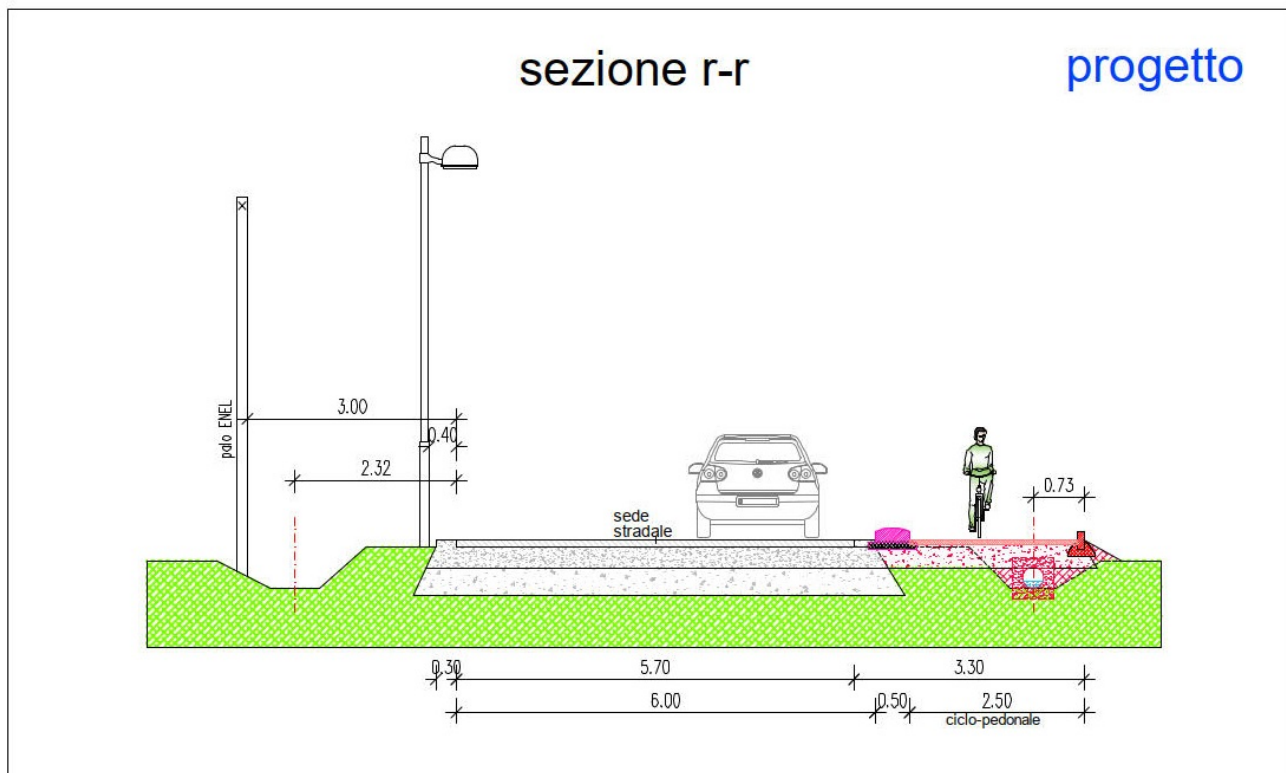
VIA CARPI ciclopedonale in progetto -SEZIONE TIPO-
